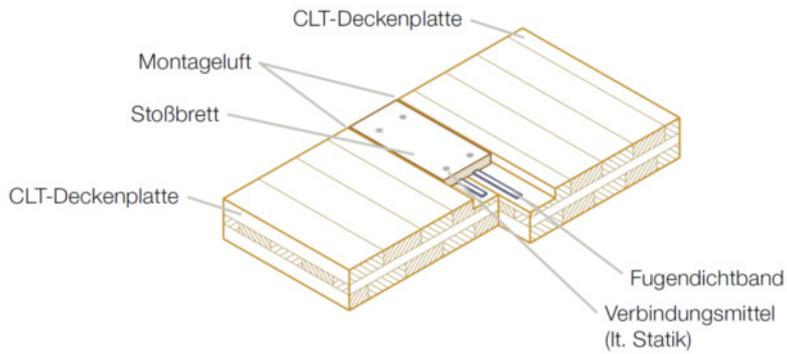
Deckenstoß mittels Stoßbrett ¹⁶⁷
